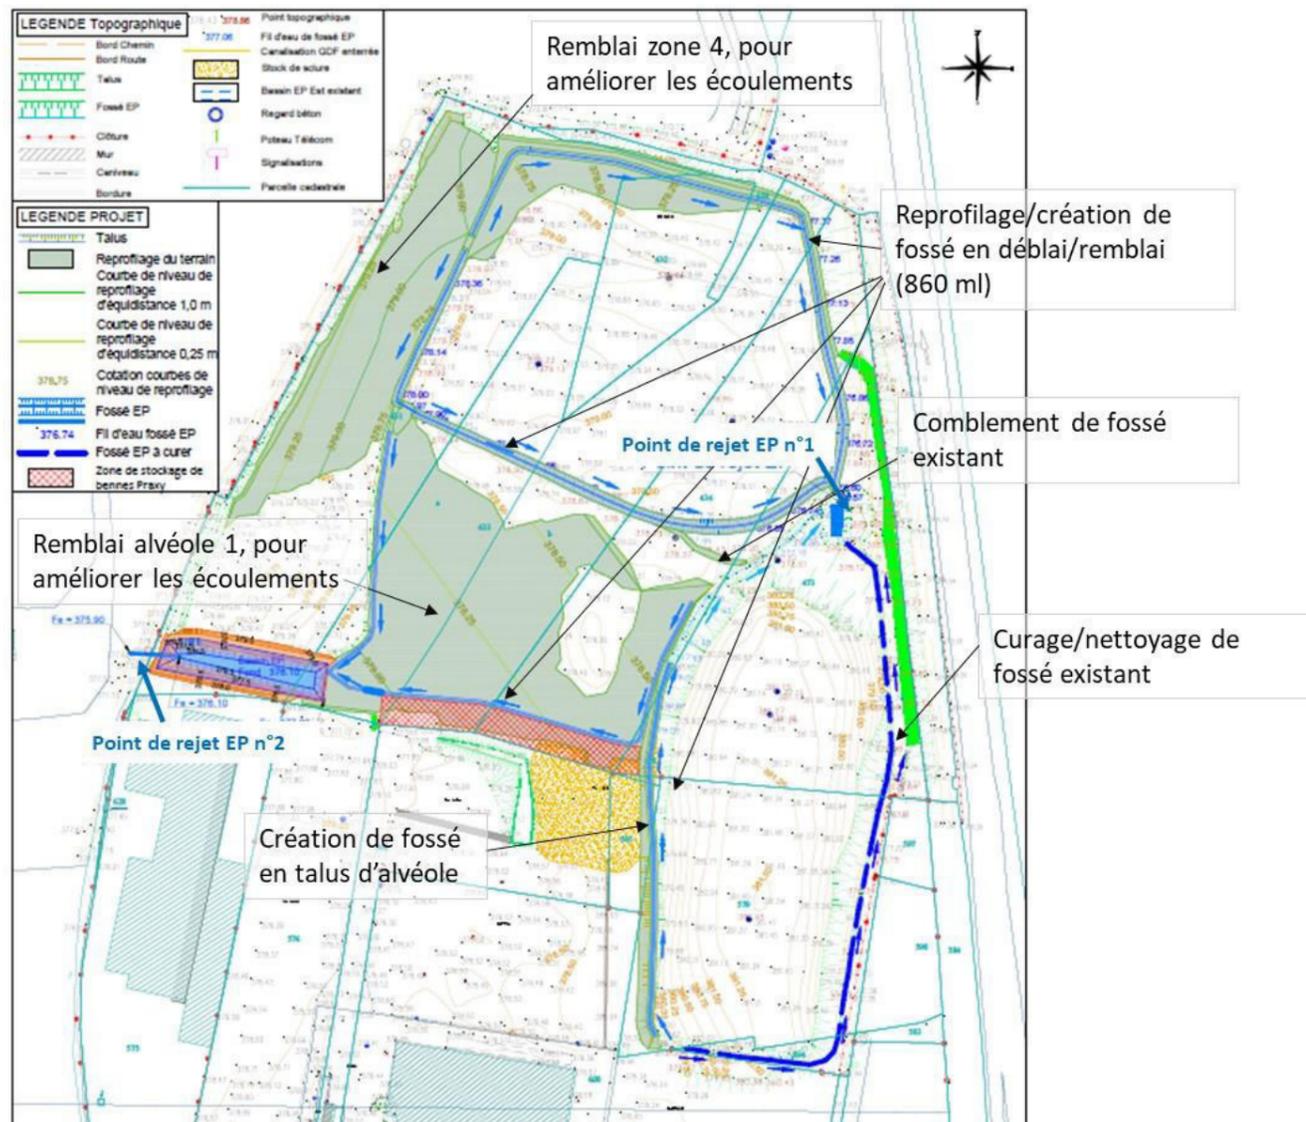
Présentation des travaux de remodelage et de gestion des eaux pluviales (extrait du plan de l'annexe 2)
